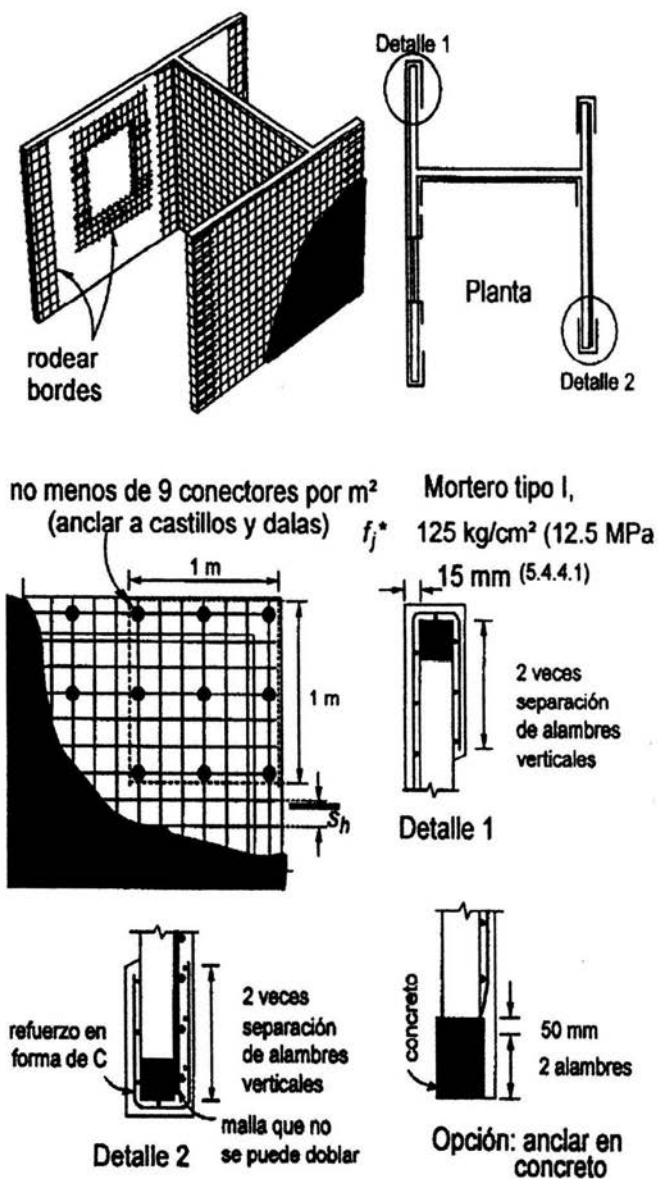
Detalles de la colocación de encamisado con malla metálica.
